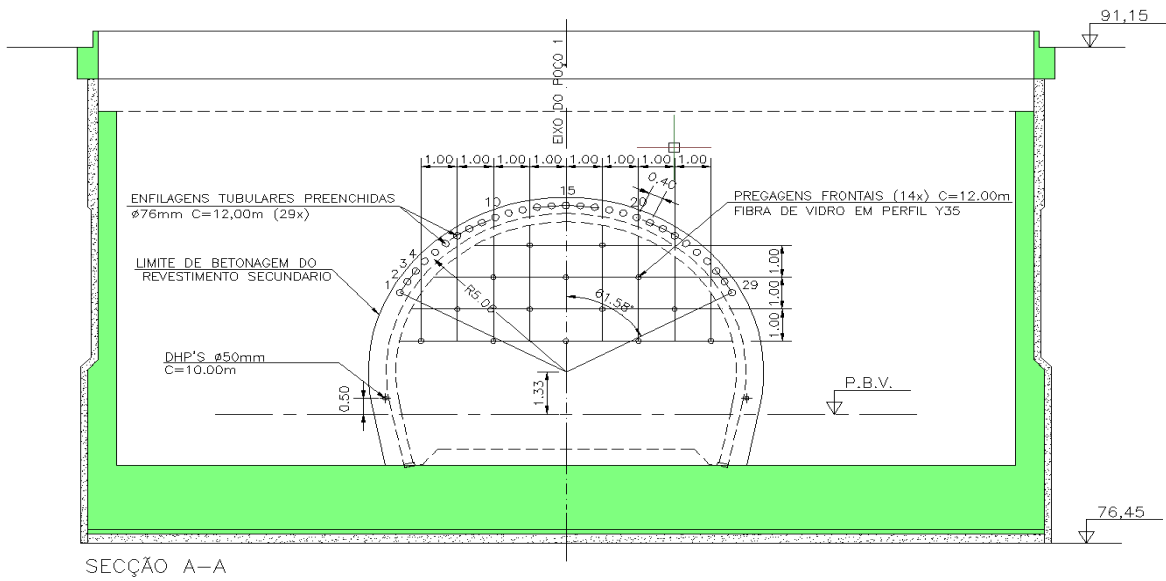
Esquema de tratamento do emboquilhamento norte (Adaptado CJC, 2008).
